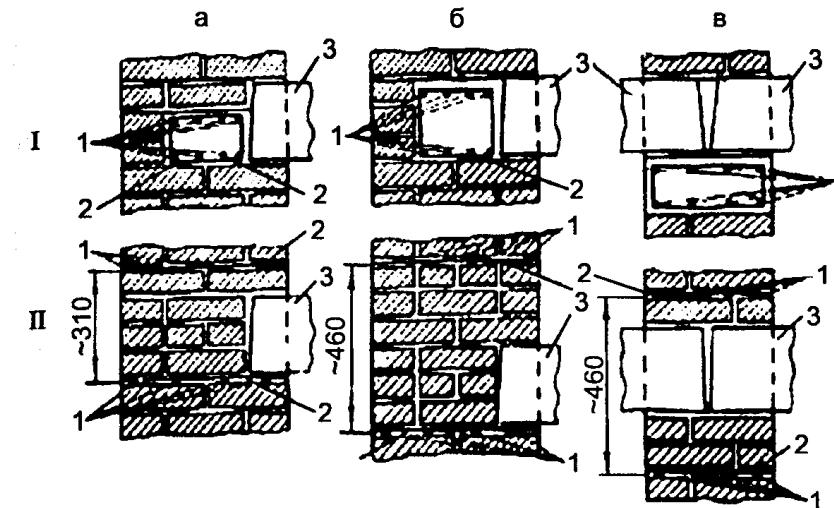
Схема равнопрочных железобетонных (I) и армокаменных (II) поясов (бетон В12,5; раствор М50; армирование поперечными стержнями Ф 6А-1 с шагом 150 мм) (а — наружных стен при сечении железобетонного пояса 250×150 мм; б — наружных стен при сечении железобетонного пояса 250×220 мм; в — внутренних стен при сечении железобетонного пояса 380×150 мм):
